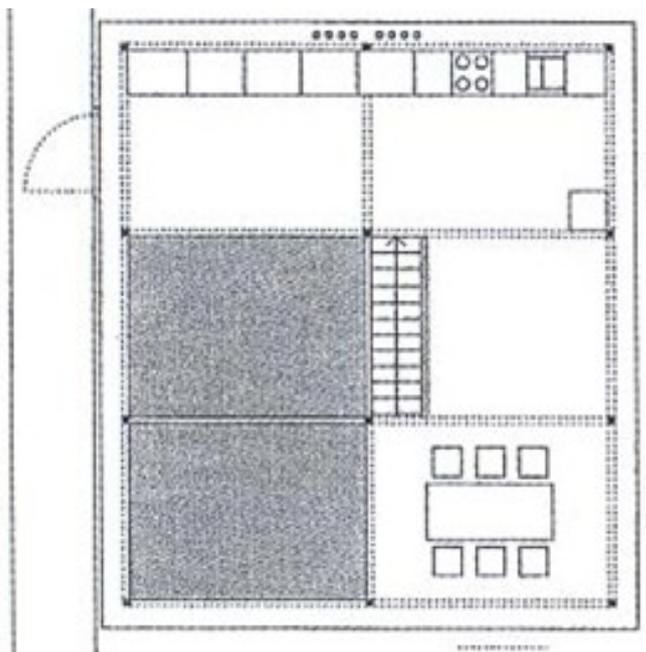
Sobek Haus, R 128, Grundriss Küchenebene, Quelle: [www.wernersobek.de](http://www.wernersobek.de)
